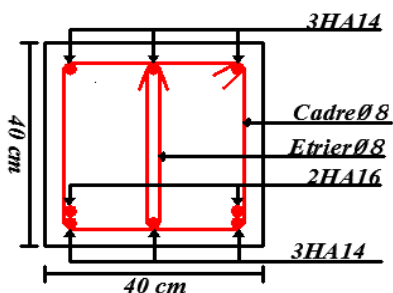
Schéma de ferrailage de la poutre de palière en travée
